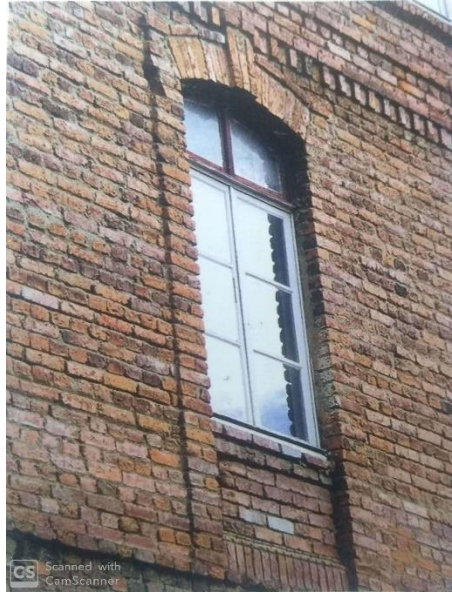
Arco rebajado que estructura el vano de la ventana. Residencia Beaulier Av. Colón 630-636
